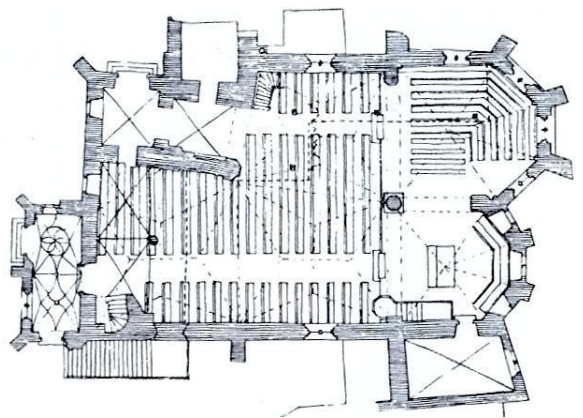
Traben, ev. Pfarrkirche, Grundriss
